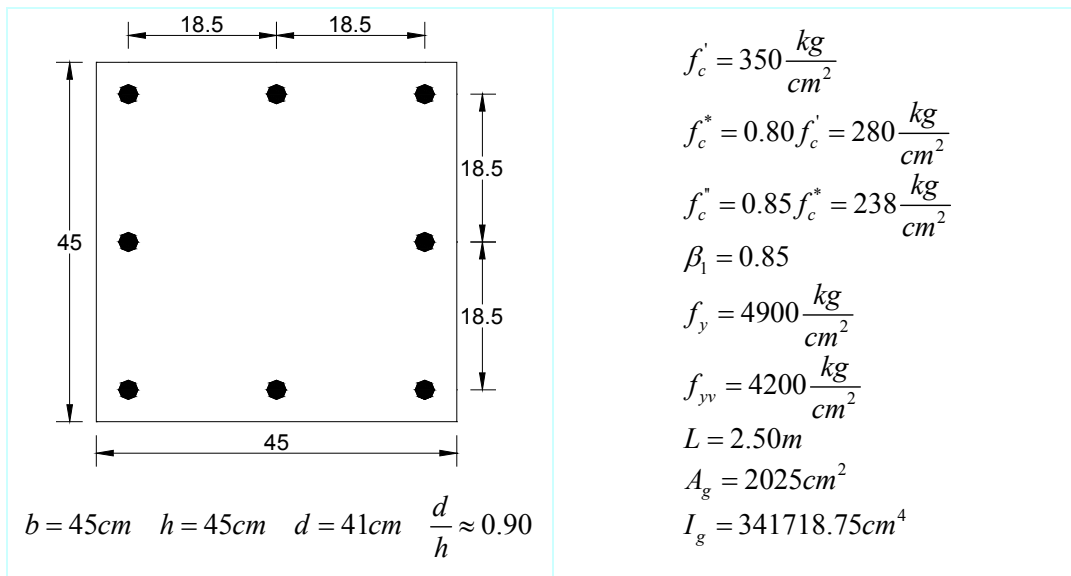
Sección transversal de la columna C45x45 (dimensiones en cm)
